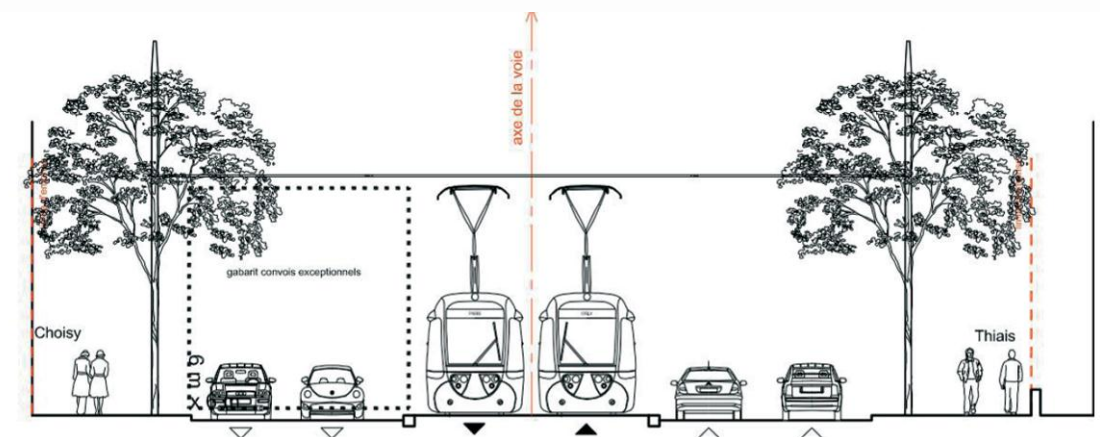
Section à 27 m entre le passage Bertrand et l'avenue Roosevelt sur Choisy / Thiais
